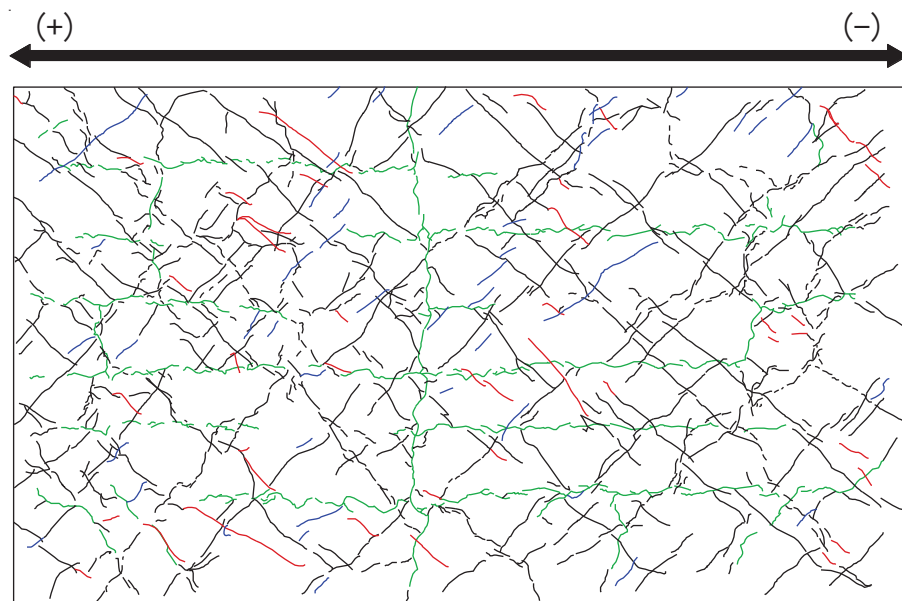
乾燥試験体 [1] 最終破壊時ひび割れ図
